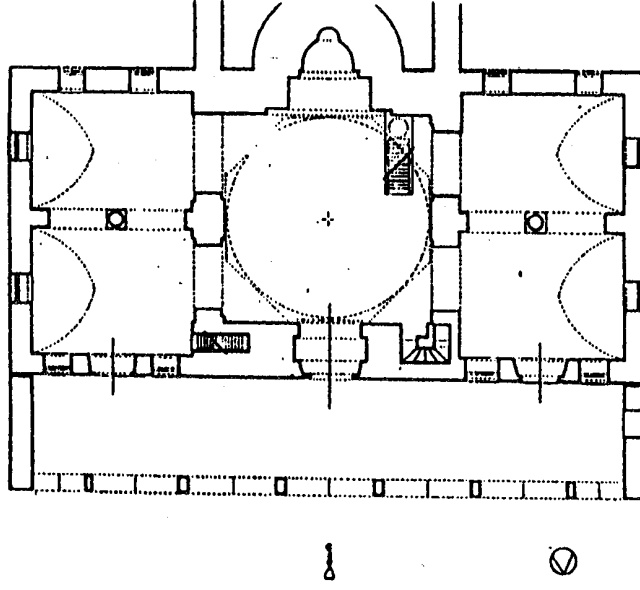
مسقط أفقي لجامع احمد باشا بديار بكر
